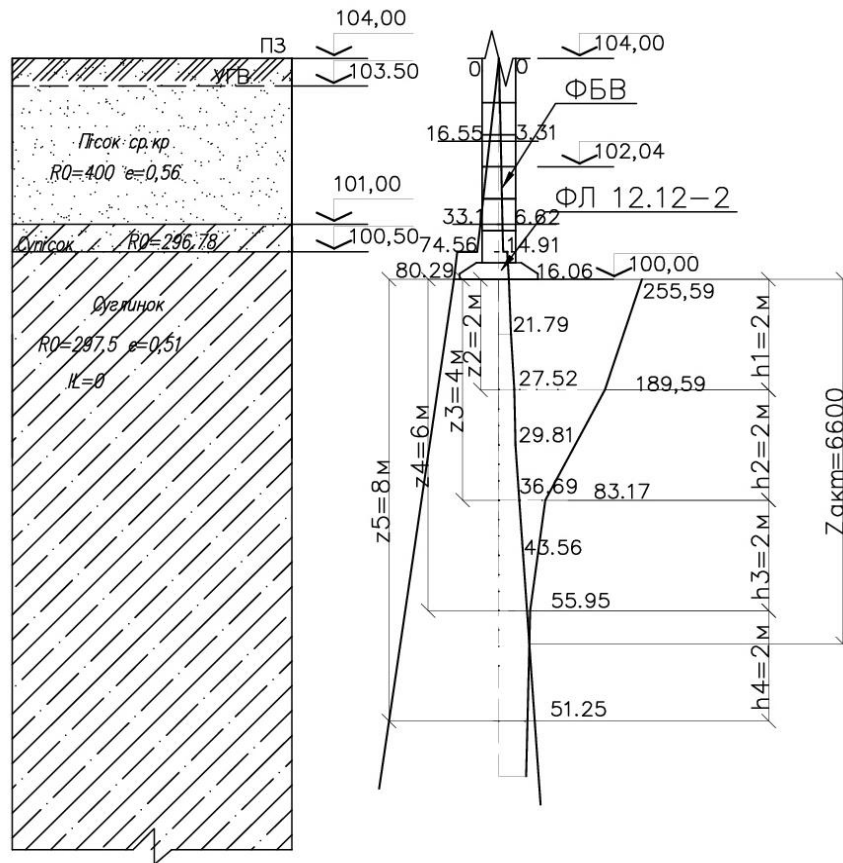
Схема розрахунку фундаменту за другим граничним станом
